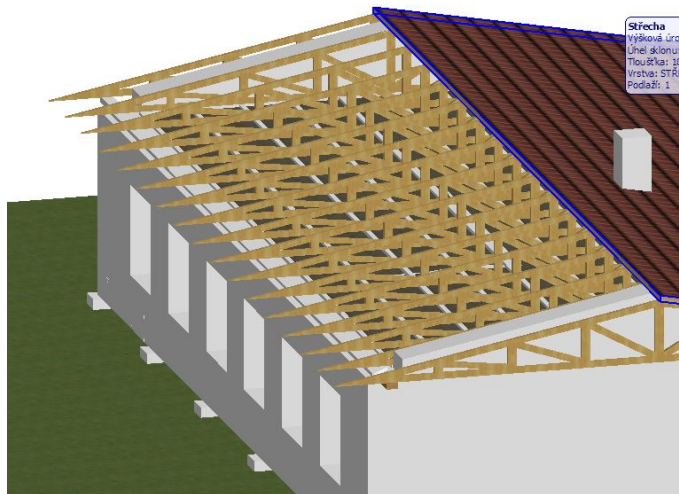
Střešní konstrukce z I-osb nosníků – do otevřené střešní konstrukce (Archicad 2010)
